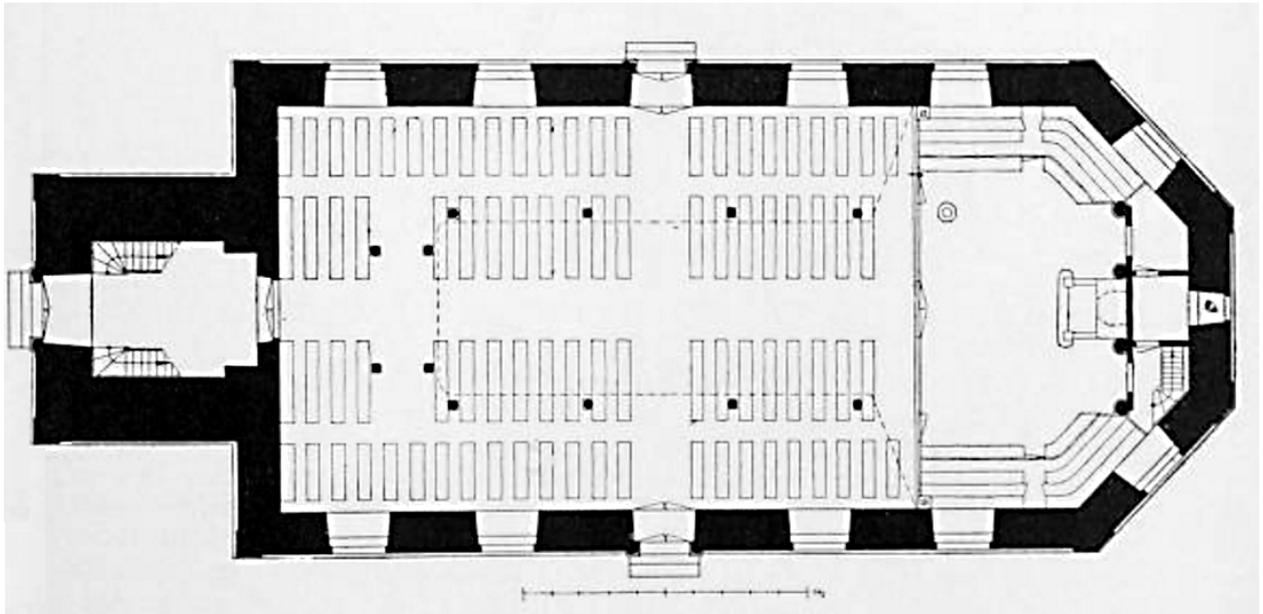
Der Grundriss von St. Peter und Paul zeigt das Schema einer typischen protestantischen Saalkirche mit Kanzelaltar und Emporen.
